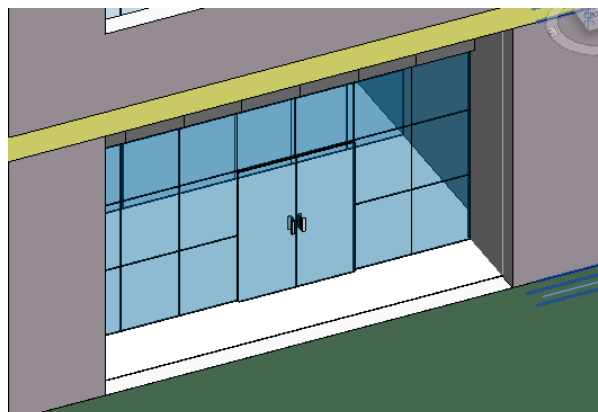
Ventanas fachadas este y oeste Revit
